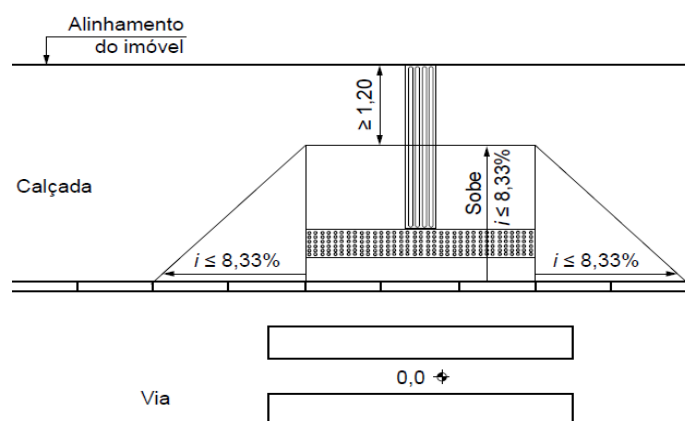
Esquema para rebaixamento de calçada. (ABNT NBR 9050:2015)
